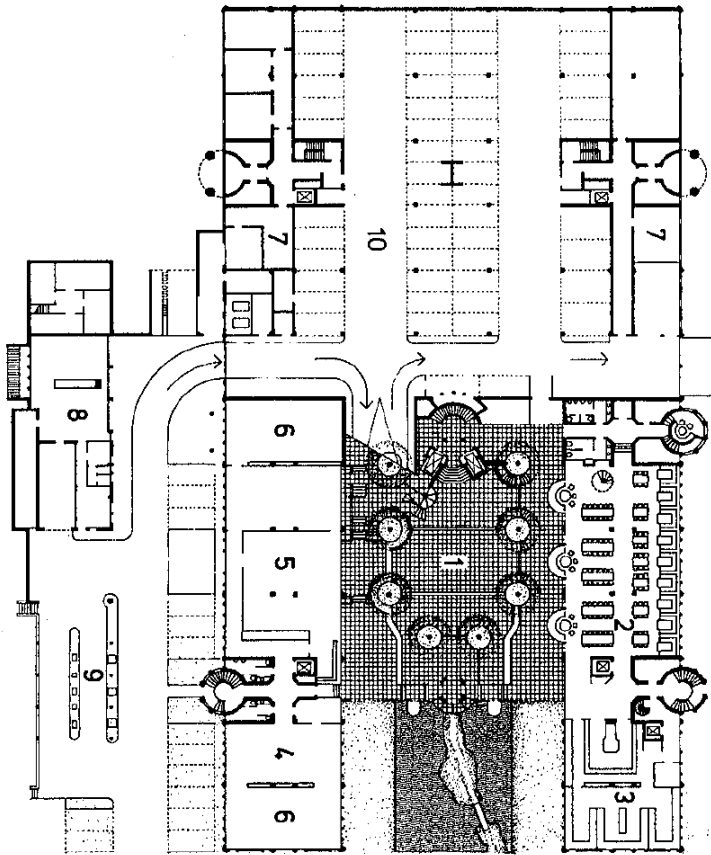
1. Untergeschoss<sup>1</sup>
